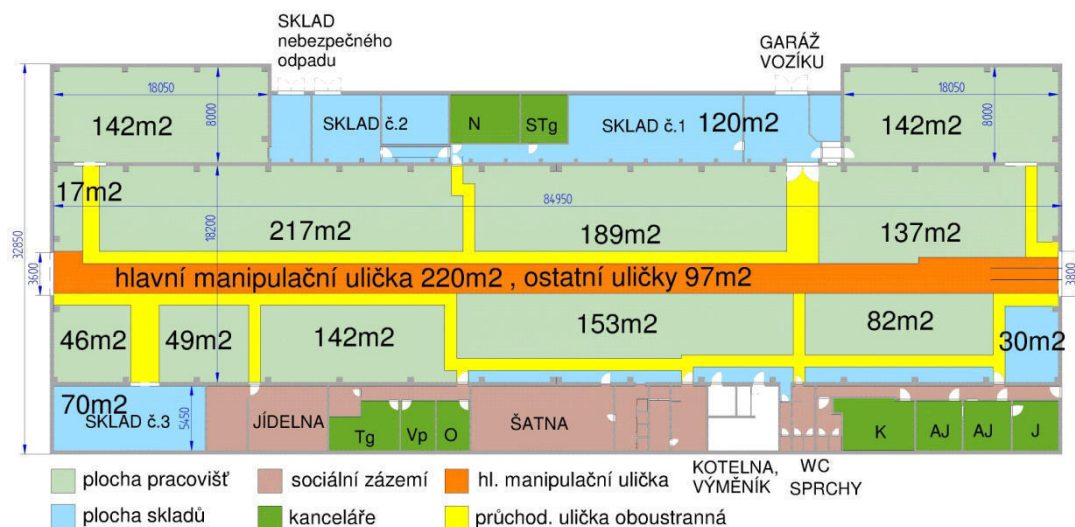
Layout současné provozovny – svařovací pracoviště
